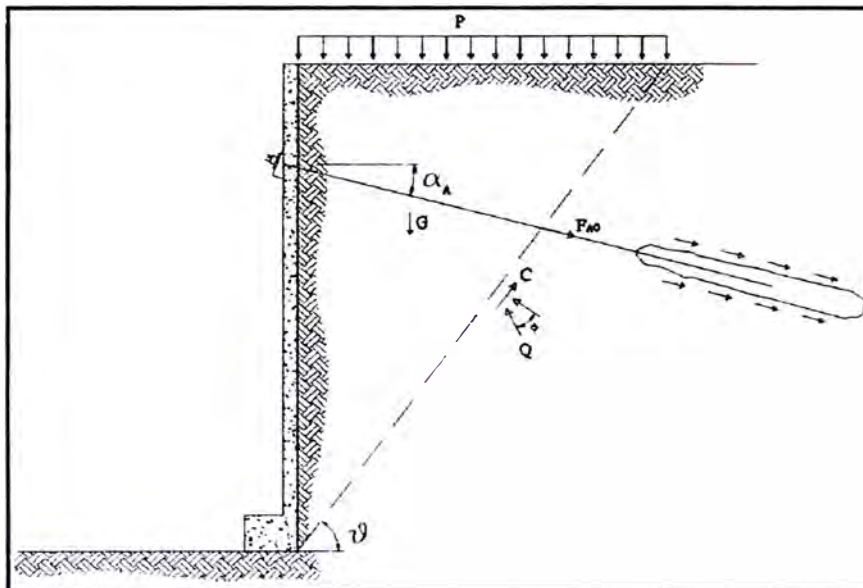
Cargas actuantes en un plano de falla reforzado con anclajes activos
